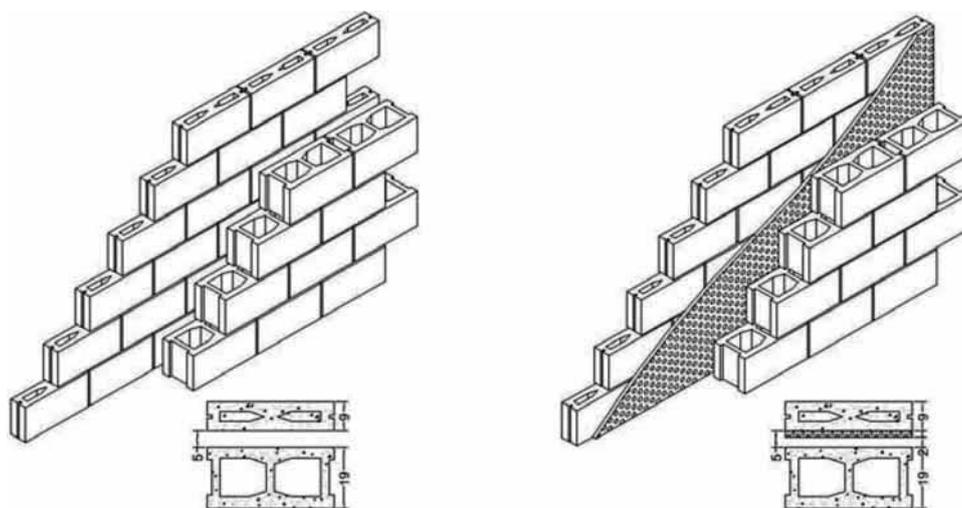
[Izquierda]: Muro de 2 hojas de bloque de hormigón. [Derecha]: Muro de 2 hojas de bloque de hormigón + 2cm aislamiento.
